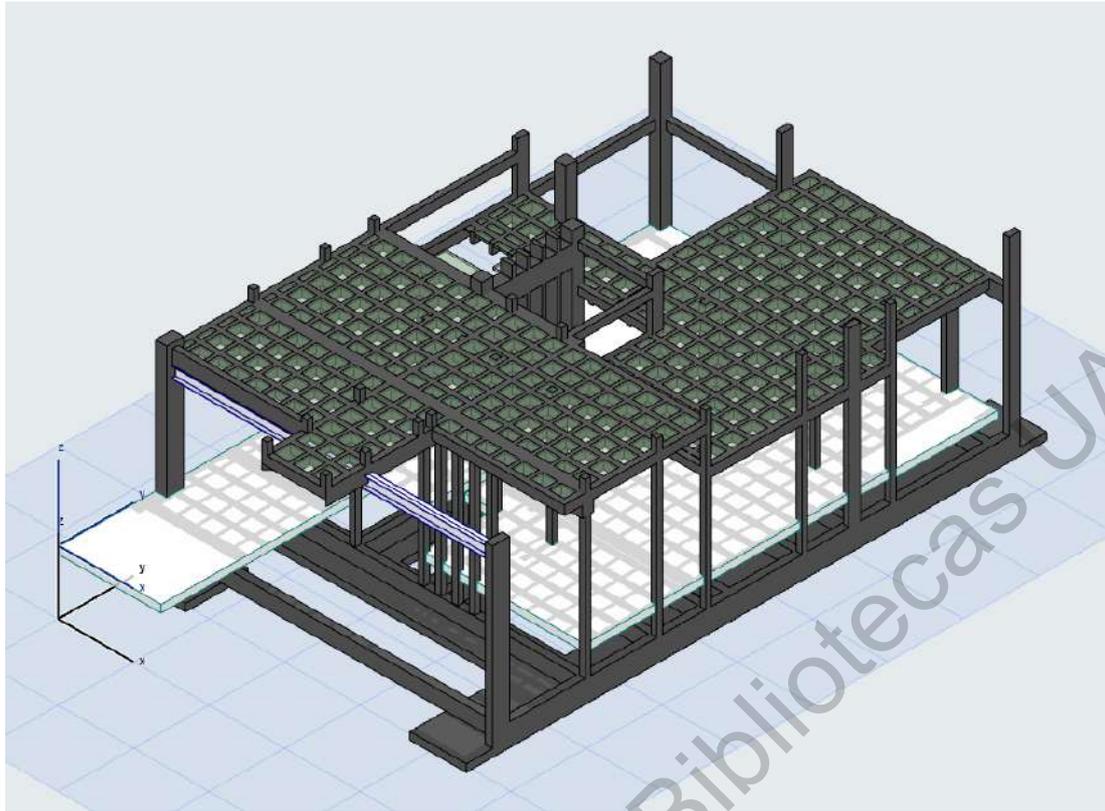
Losas de Concreto de Primer Nivel de Proyecto 003.
